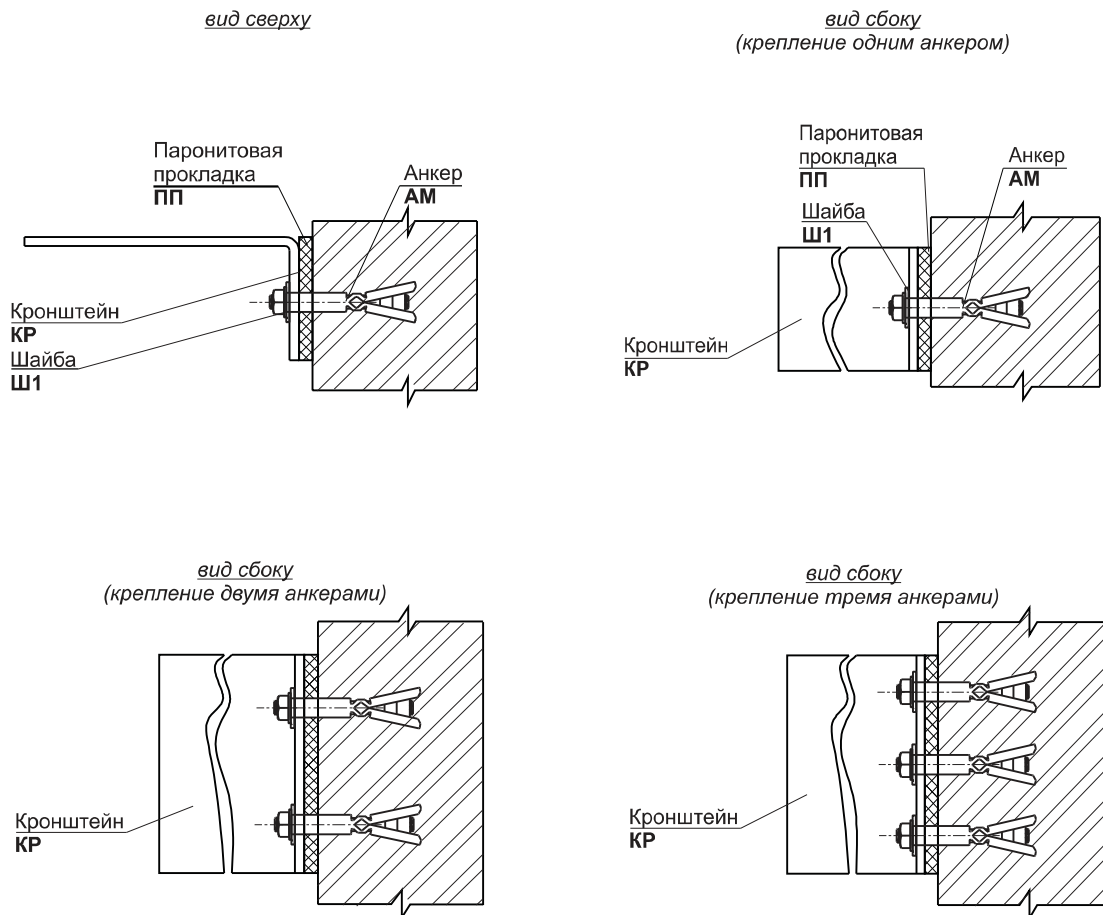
Узел крепления кронштейна КР, КРУ(исполнение 1) к стене.
